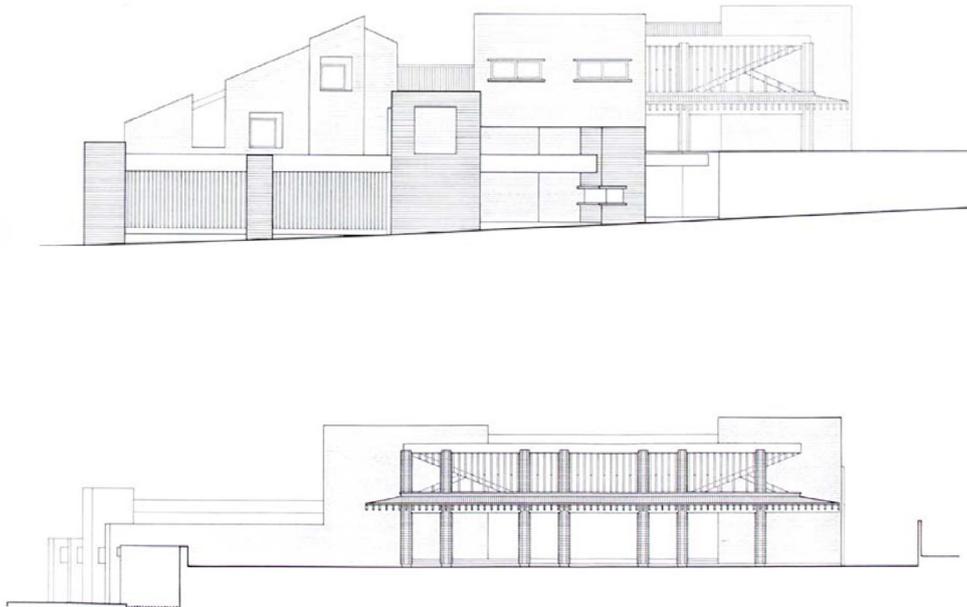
proyecto de arquitectura (elevación Este y elevación Norte) casa Kavac
